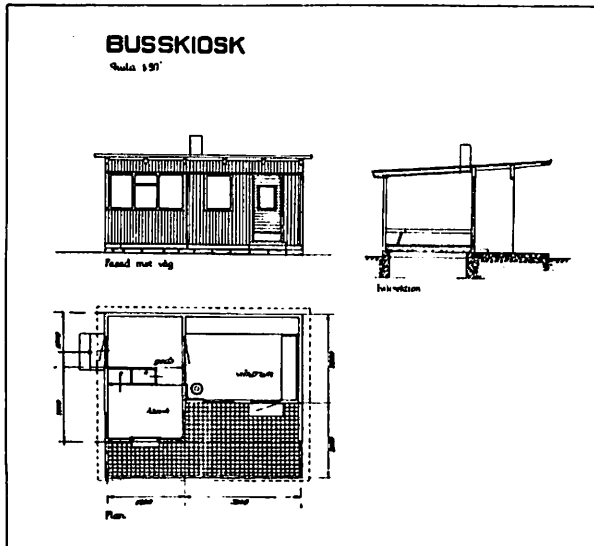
Busskiosk. Elevation, tvärsnitt och plan.
